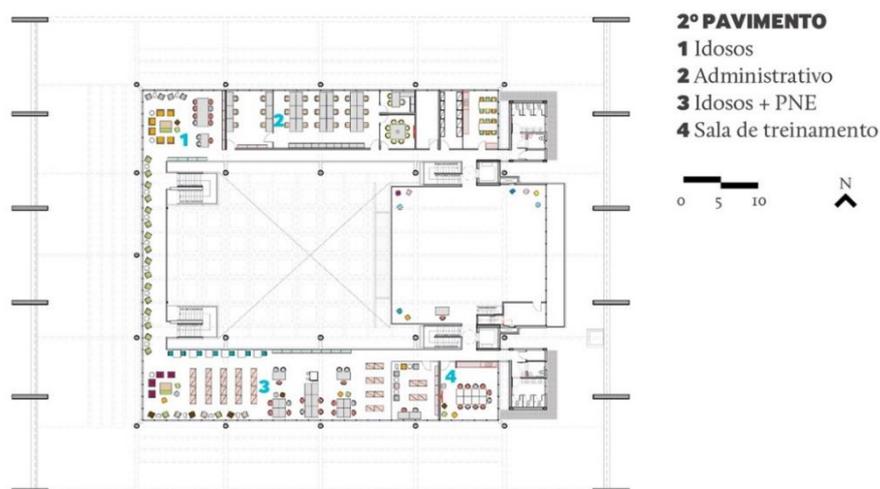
Plantas técnicas do projeto Villa Lobos, São Paulo.
